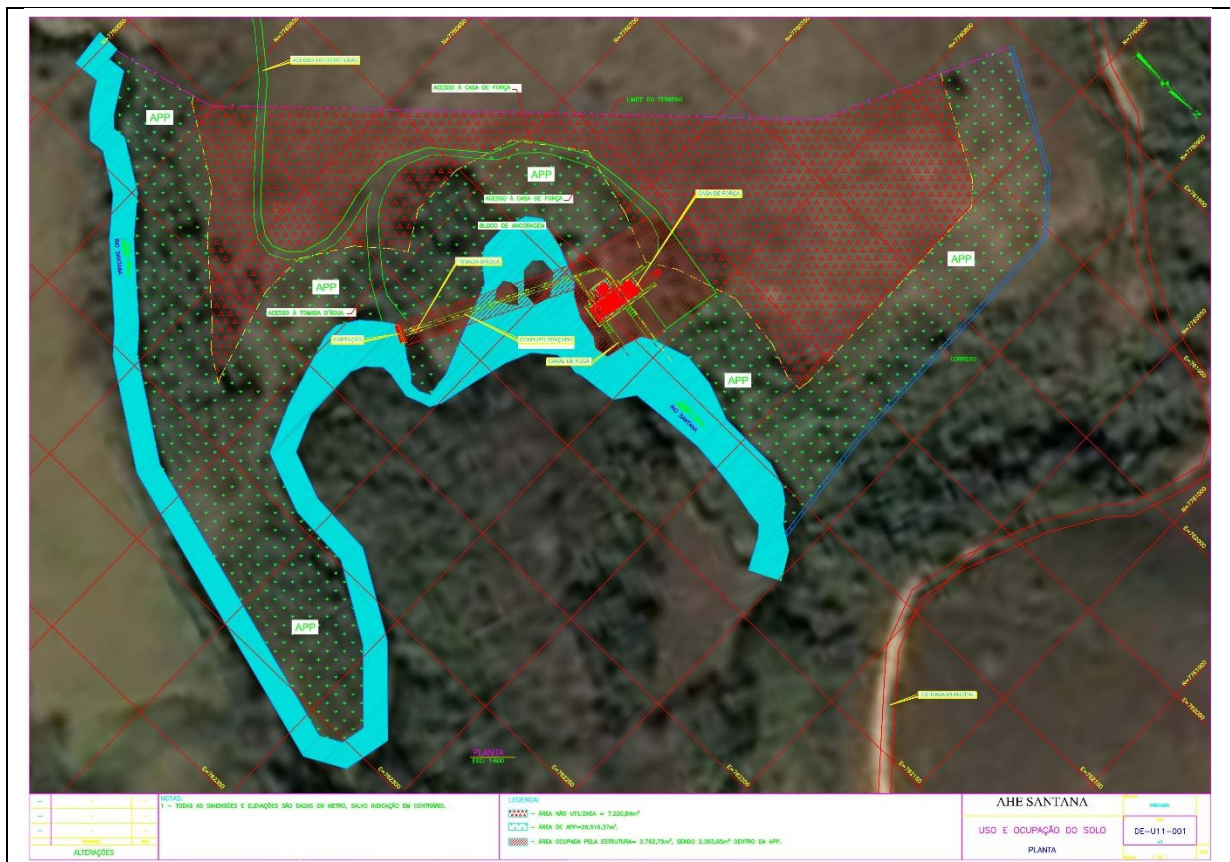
Planta AHE Santana – Uso e Ocupação do Solo.
